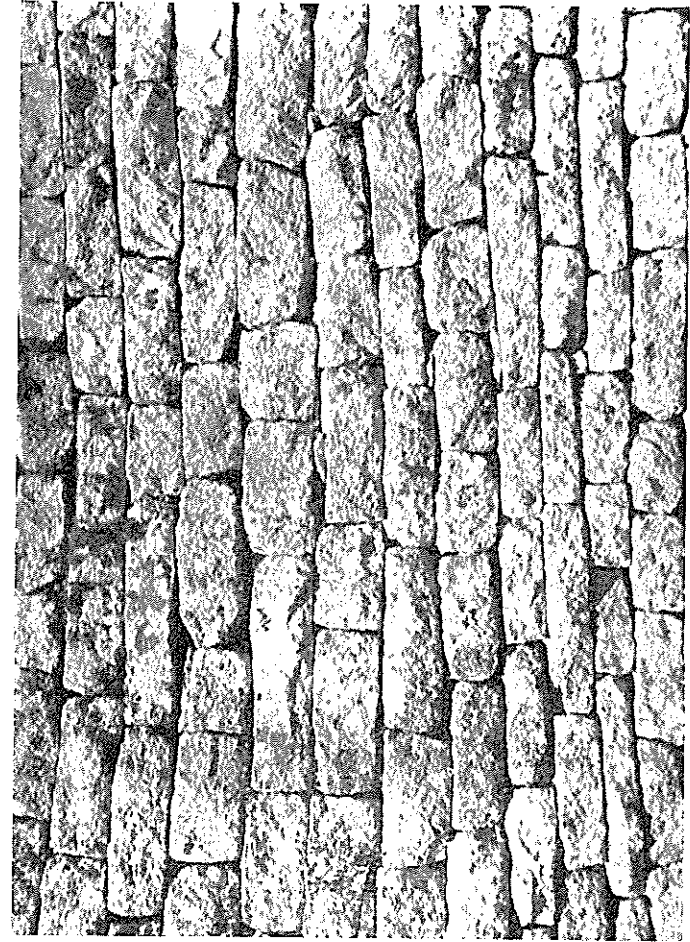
Pormenor da muralha do templo elitico de Zimbaué, para mostrar a sua construção feita com pedras de secção rectangular sem interposição de qualquer cimento ou argamassa. A este tipo arquitectónico pode bem chamar-se *opus rectangularis*.
